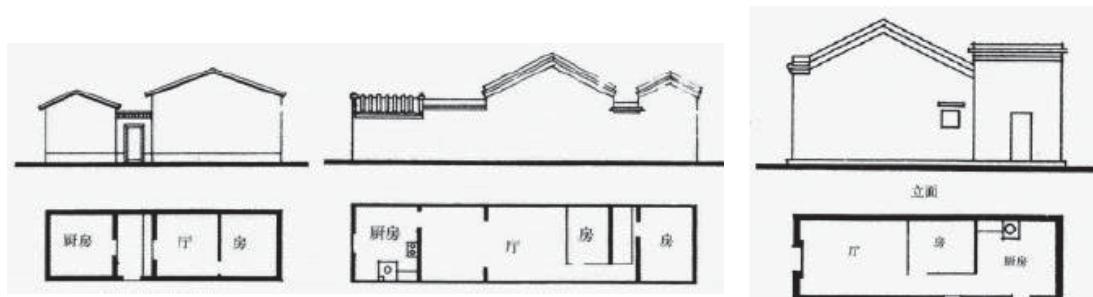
各種竹筒屋の平面と立面 出典：「廣東民居」、陸元鼎編著
